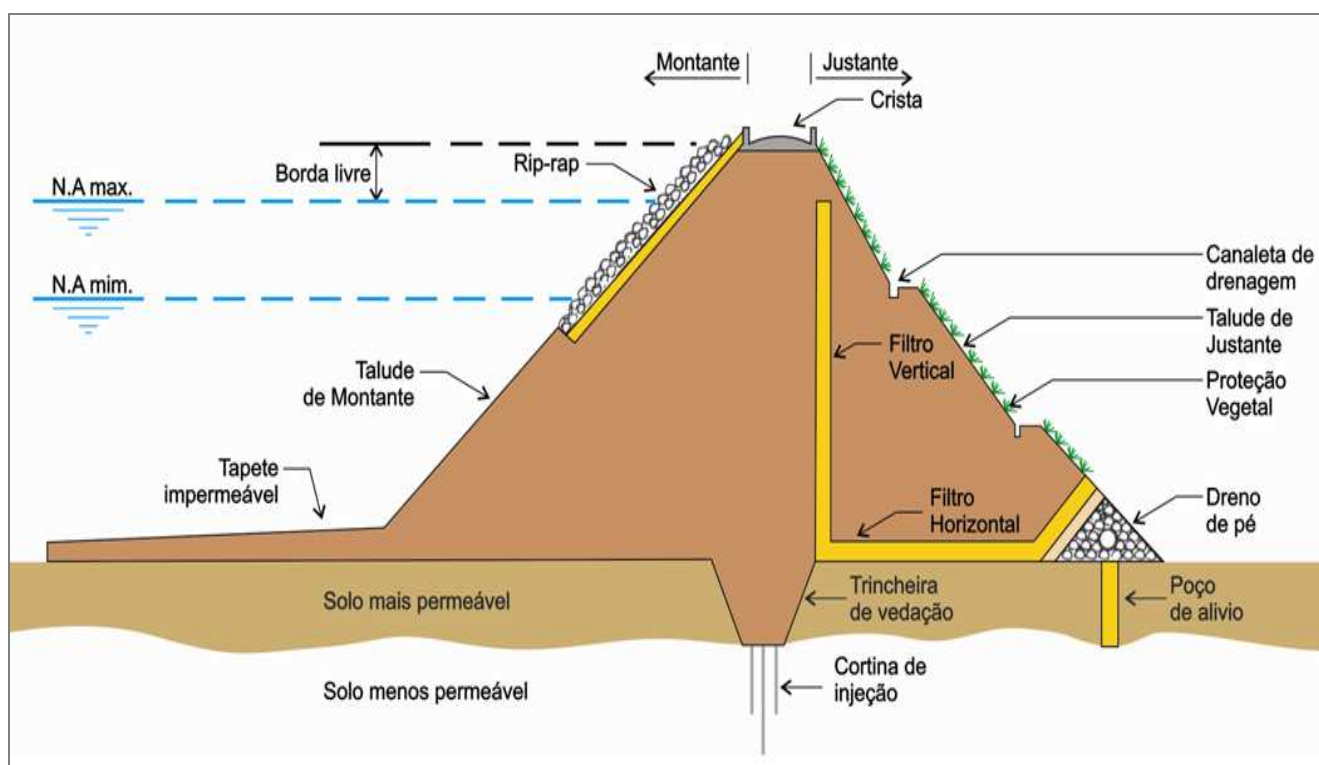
Principais elementos de uma barragem de terra – Barragem Homogênea
